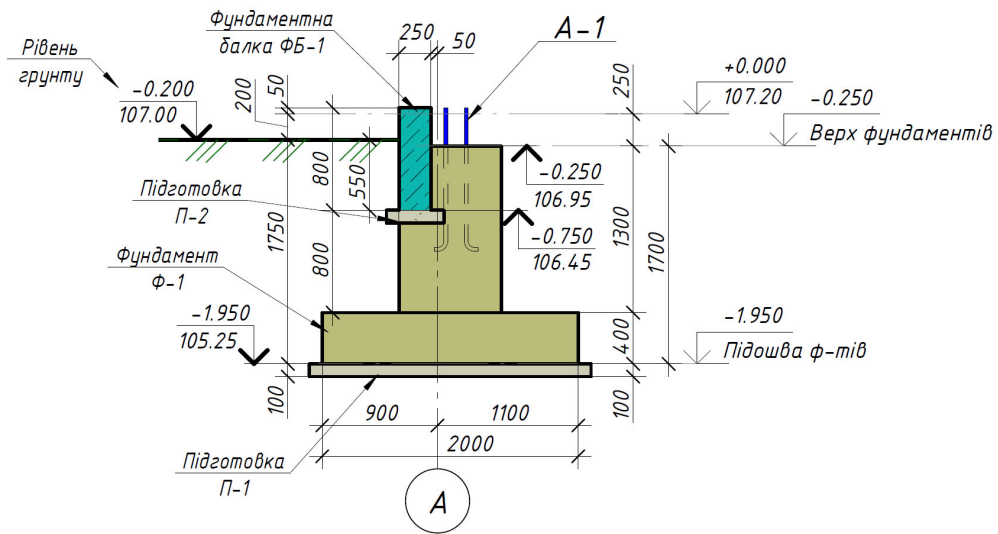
Приклад креслення фундаменту неглибокого закладання під крайню колону.
